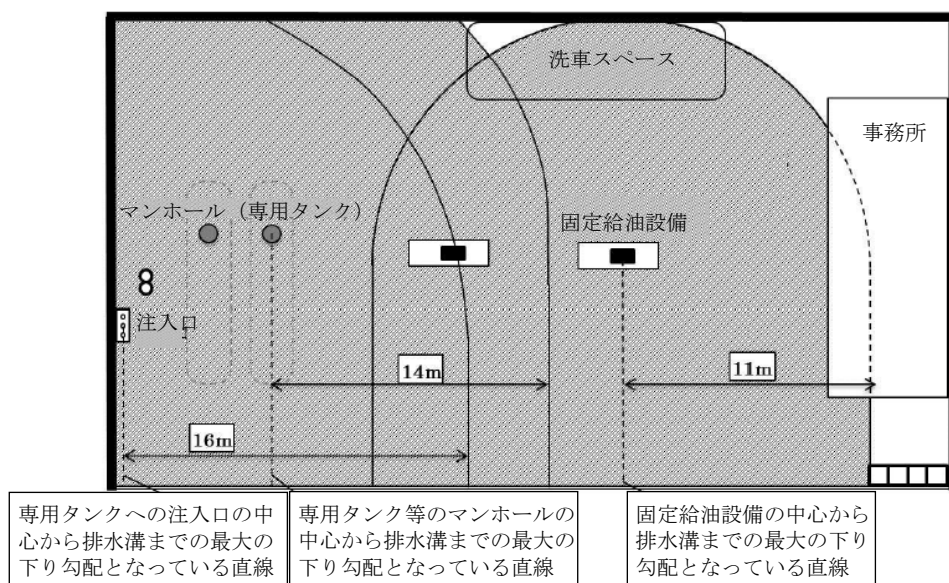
給油取扱所の急速充電設備を設置できない範囲（平面図）
